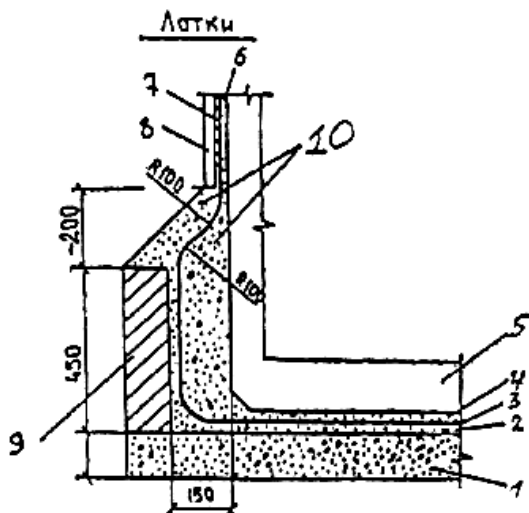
Конструкция гидроизоляции лотка и нижней части стен:
